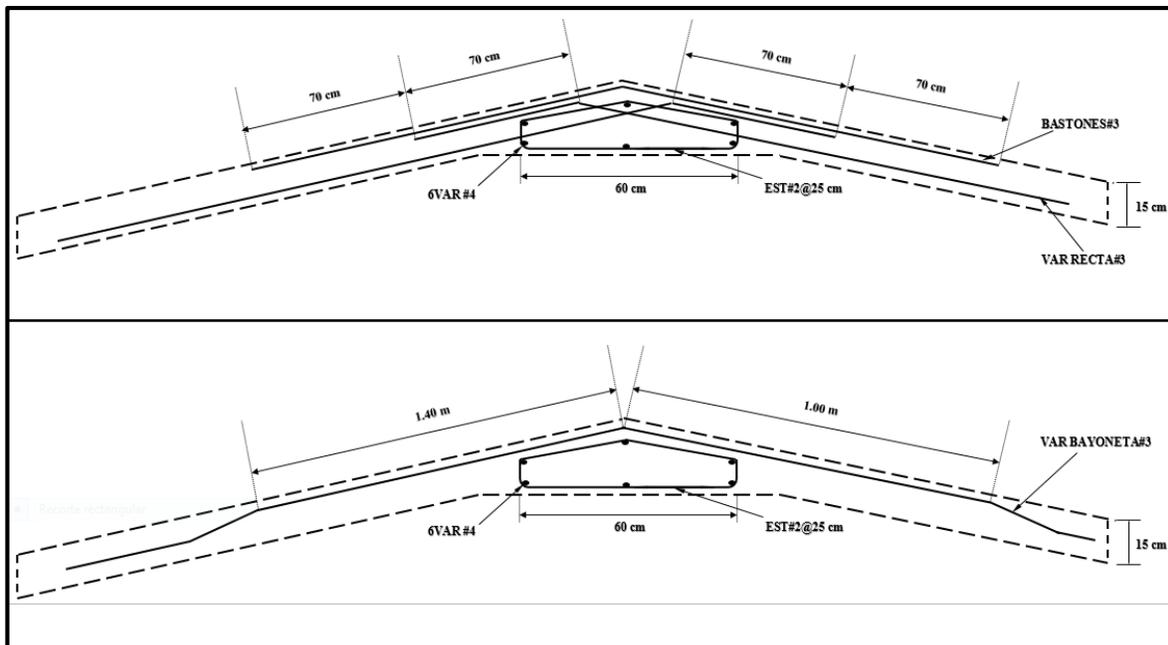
Detalles del armado de la losa de azotea de nuevo Módulo
